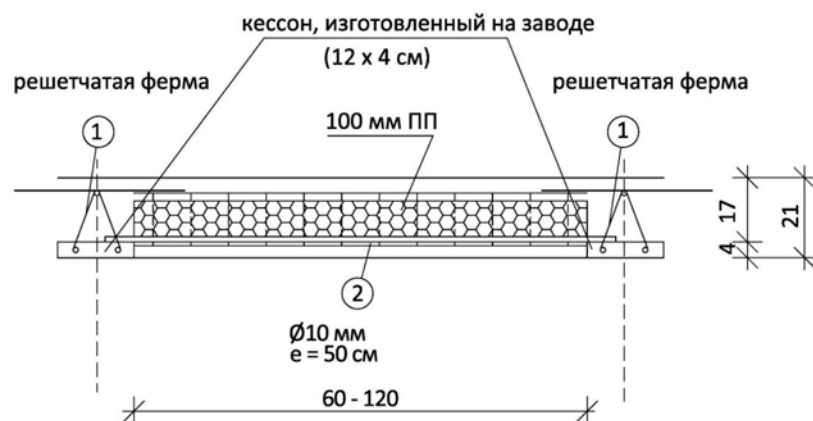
Решетчатые фермы с бетонным кессоном, изготовленным на заводе
